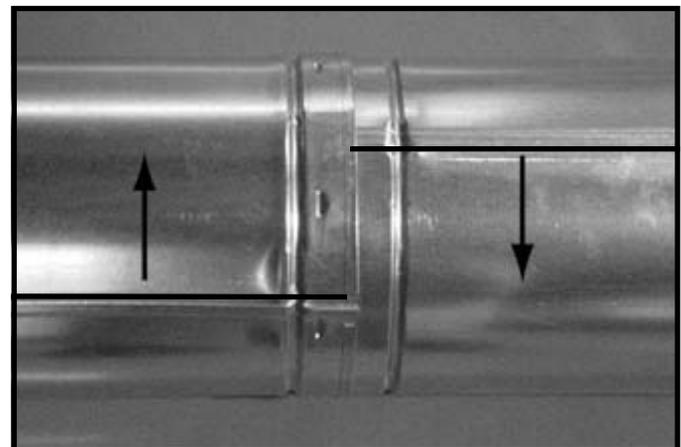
Tourner les cordons de soudure pour démonter
